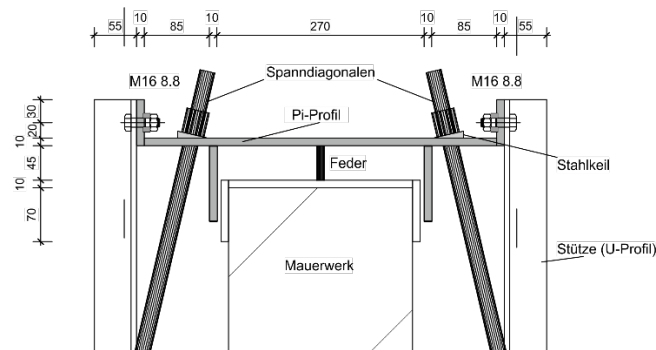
Detailansicht Prüfstand – Kopf
